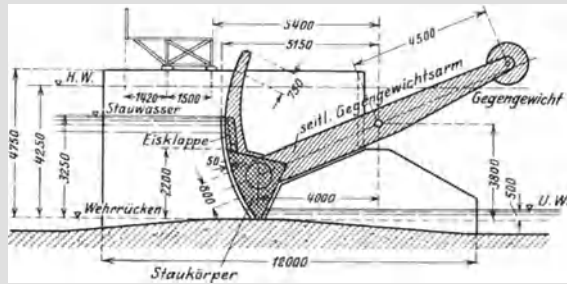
a u. b. Segmentwehr mit Gegengewicht und Eisklappe.
